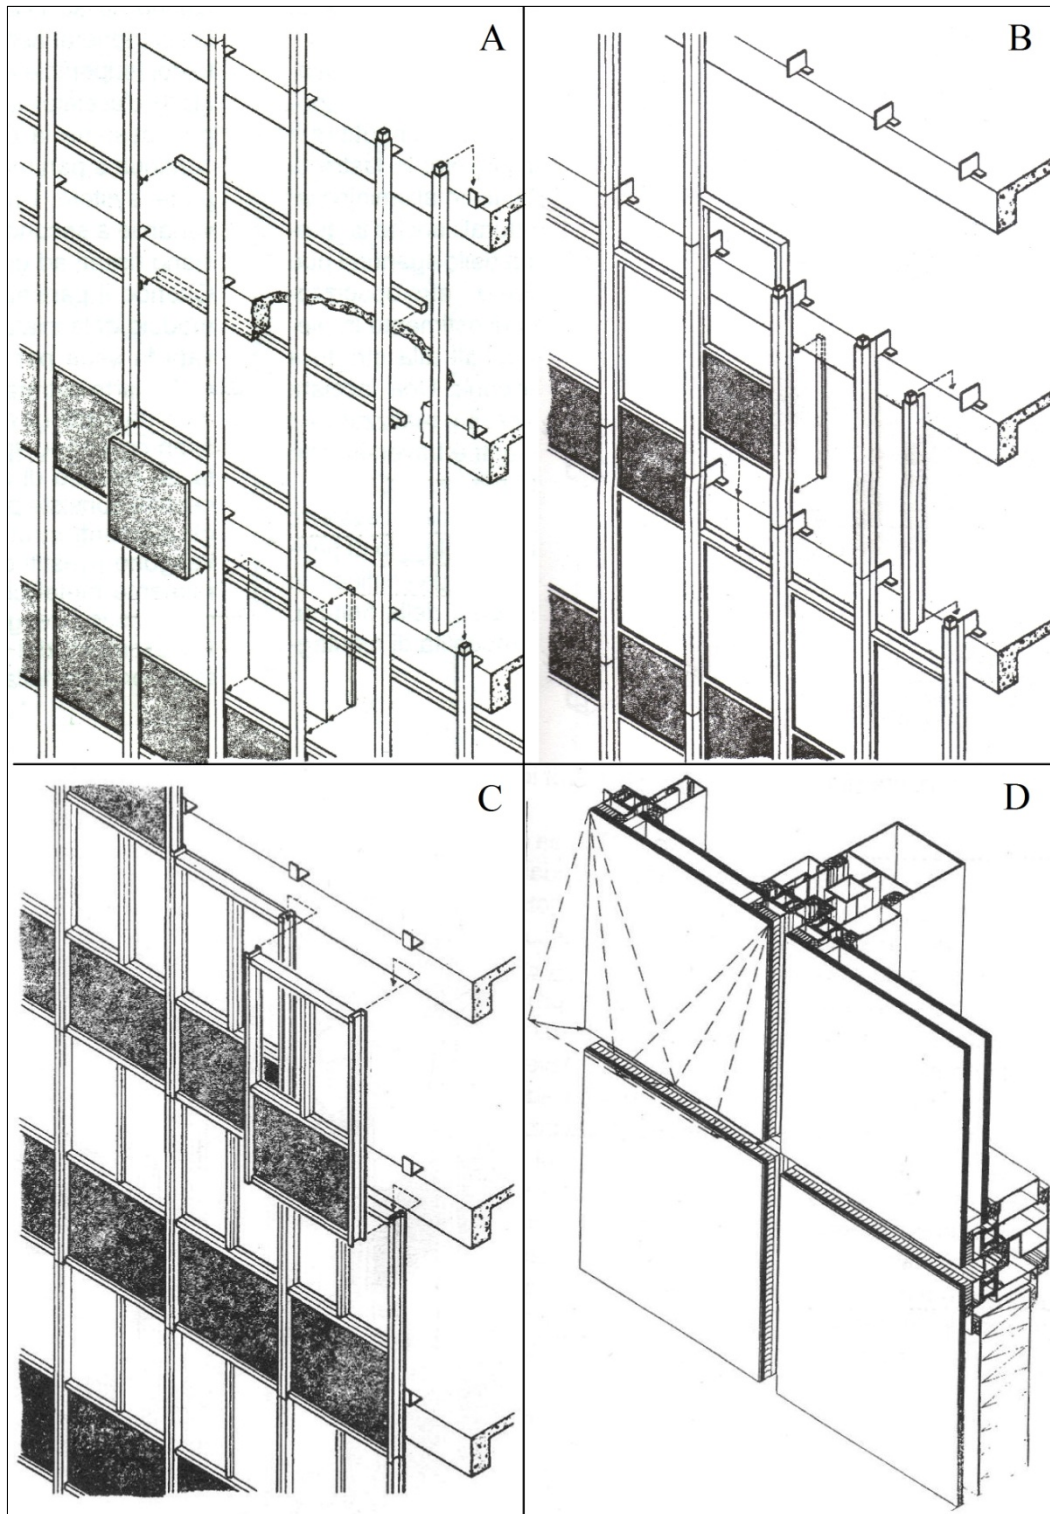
A. Facciata a montanti e traversi o Stik System – B. Facciata metallica a telai – C. Facciata ad elementi o Unit System – D. Facciata strutturale.
